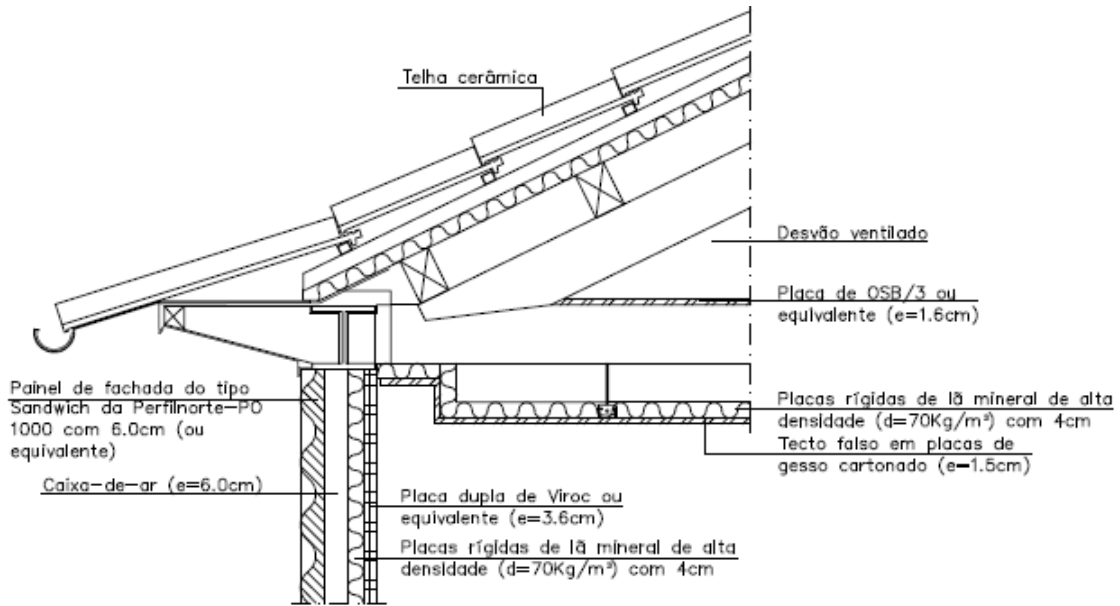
Pormenor de ligação entre a parede de fachada do piso recuado e cobertura (Projeto de CT)
